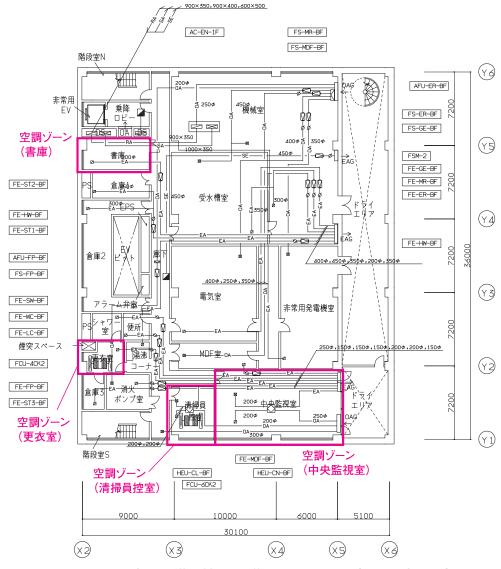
空調設備 地下 1 階ダクト平面図 (図面 - 空 - 10)
